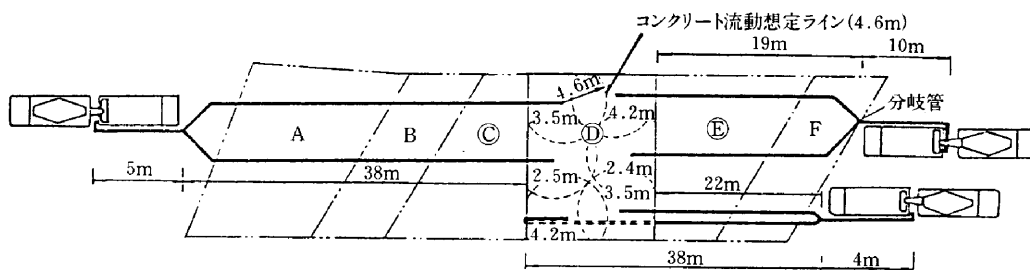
コンクリート打設用の配管（第1回施工時：I-1ランプ部）
